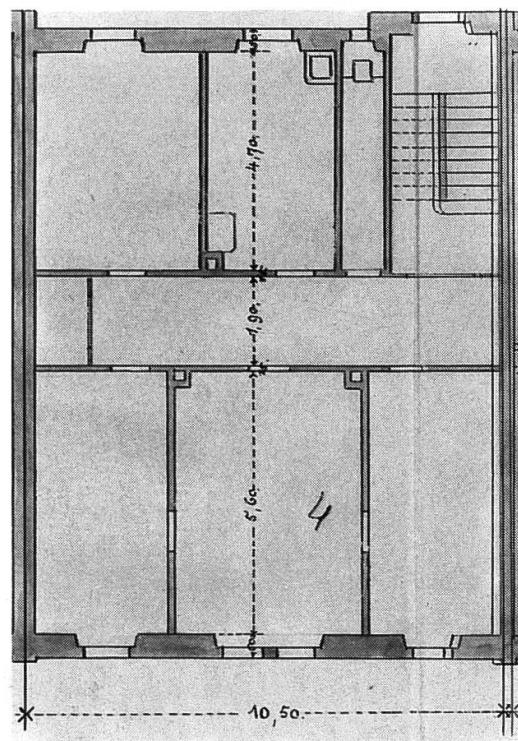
Lorrainestrasse 4. Grundriss des 1. Obergeschosses.
